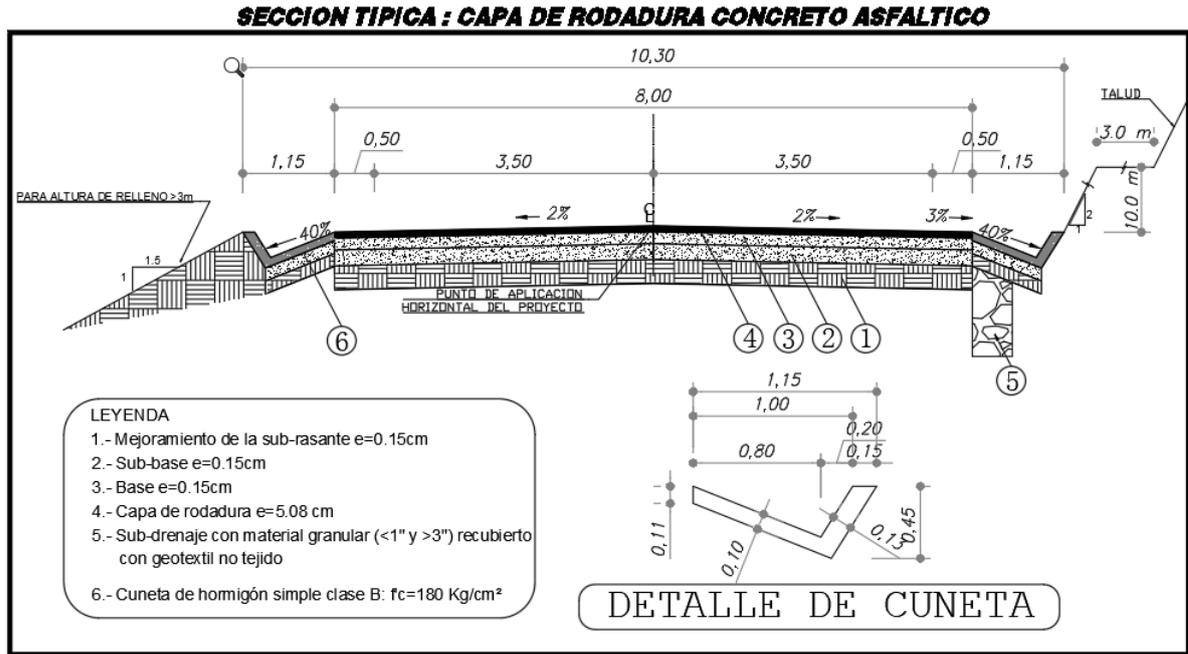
PAVIMENTO FLEXIBLE: tramo 1 (0+000 – 9+000) y tramo 4 (36+000 – 51+710)
